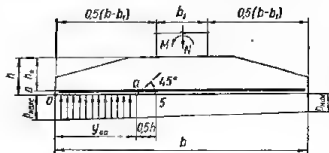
Расчетная схема к определению поперечной силы в ленточном фундаменте.
